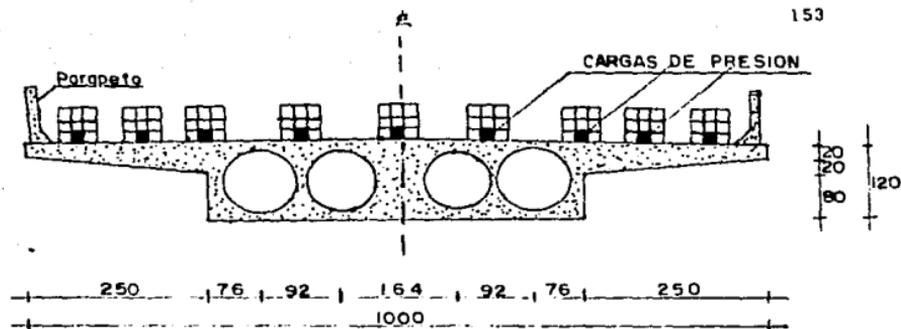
Sección aligerada (centro del claro) y colocación de cargas.
